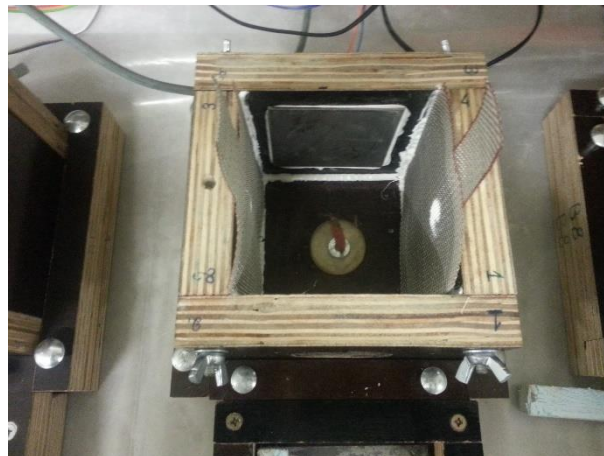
Detalhe da chapa metálica e das malhas metálicas adotadas
